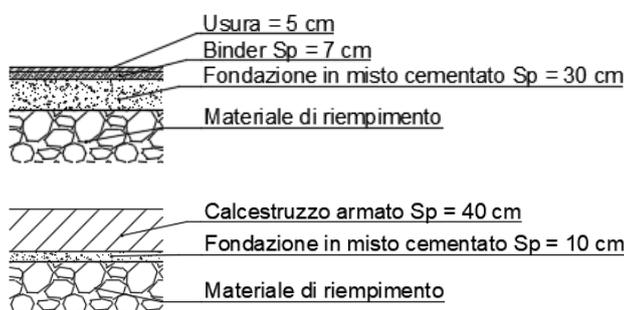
Sezioni delle pavimentazioni semirigida e rigida.
